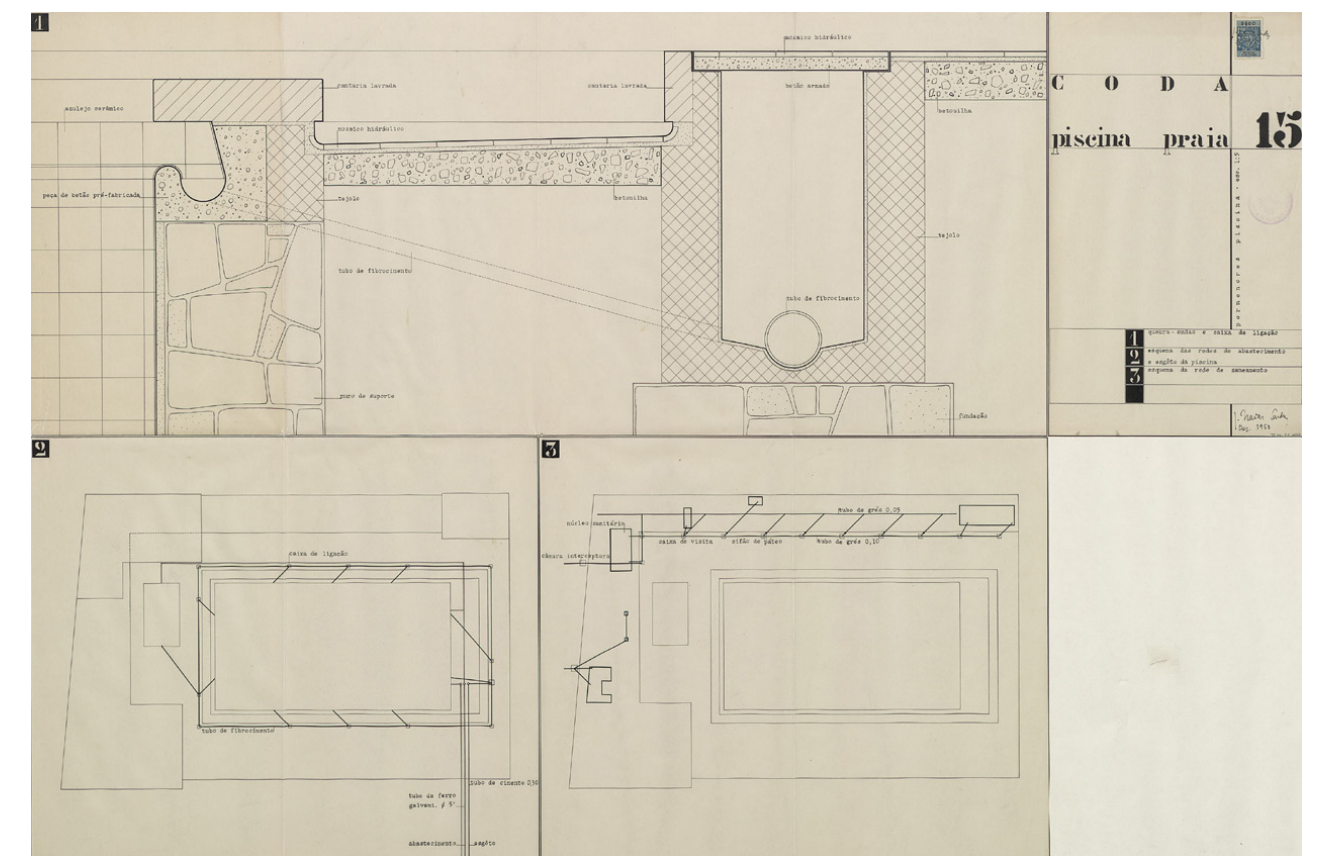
Pormenor do quebra-ondas e plantas da rede de abastecimento e saneamento da Piscina Praia da Figueira da Foz (1950-1953) - Isaias Cardoso
